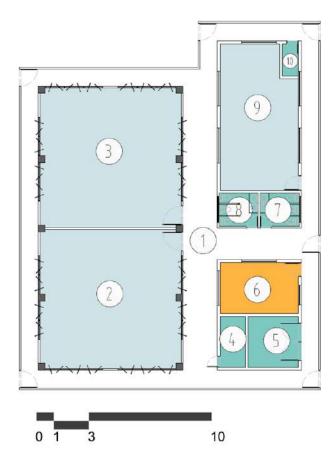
Planta 1 Bloque 48. Fuente: Equipo de diagnóstico.
